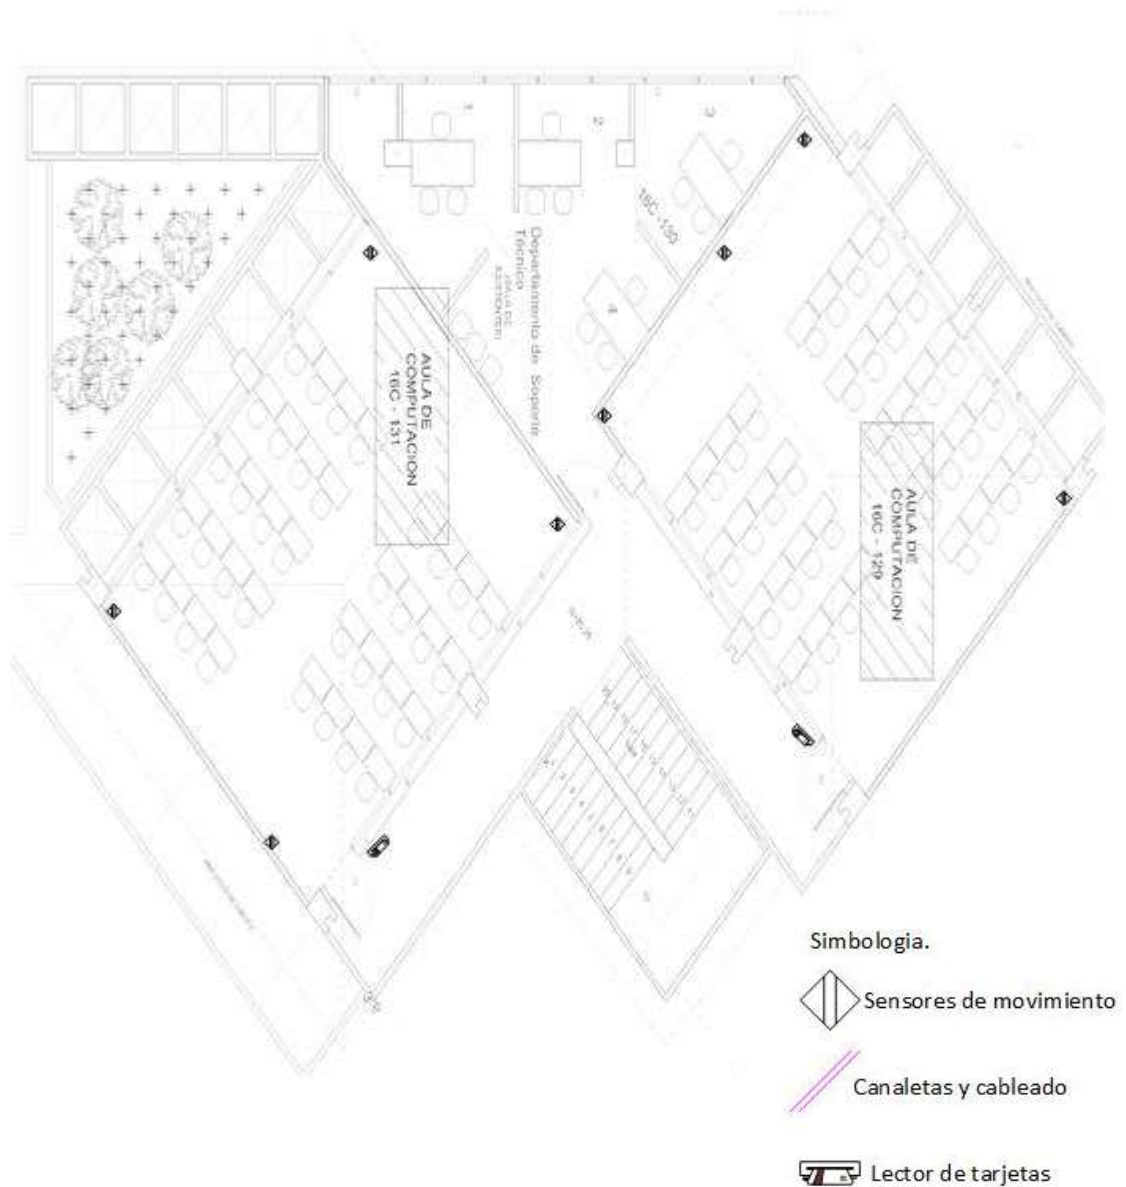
Diseño Estructural del Sistema del bloque 16C planta alta
